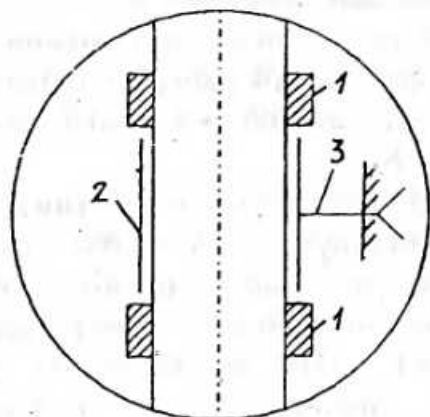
Схема нерухомої опори мідного трубопроводу: 1- мідне кільце; 2 - хомут; 3 - елемент жорсткого кріплення хомута до будівельної конструкції
